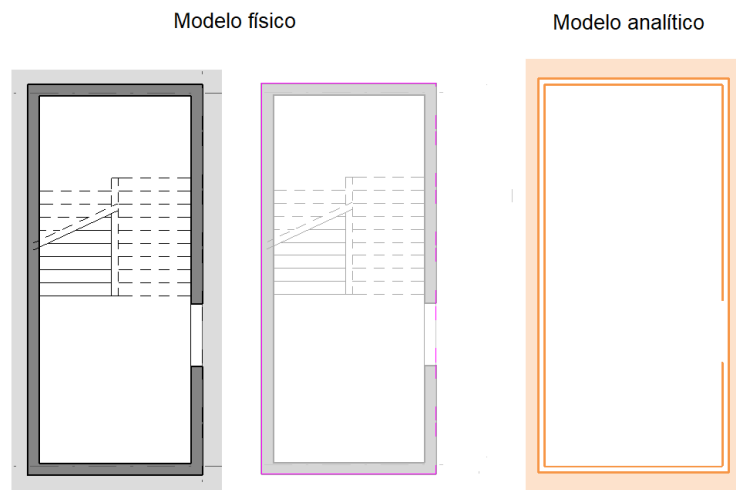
Vista em planta do modelo físico e analítico da abertura da caixa de escadas
